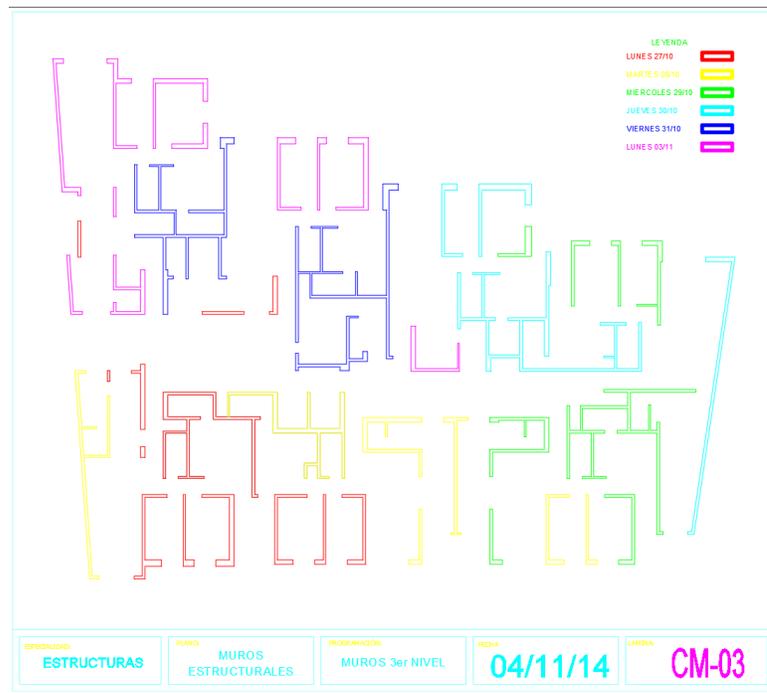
Sectorización de Muros Nivel 3. Fuente: Elaboración Propia
